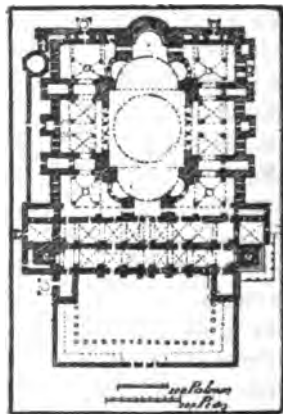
Plano de la Basílica de Santa Sofía: siglo vi.
